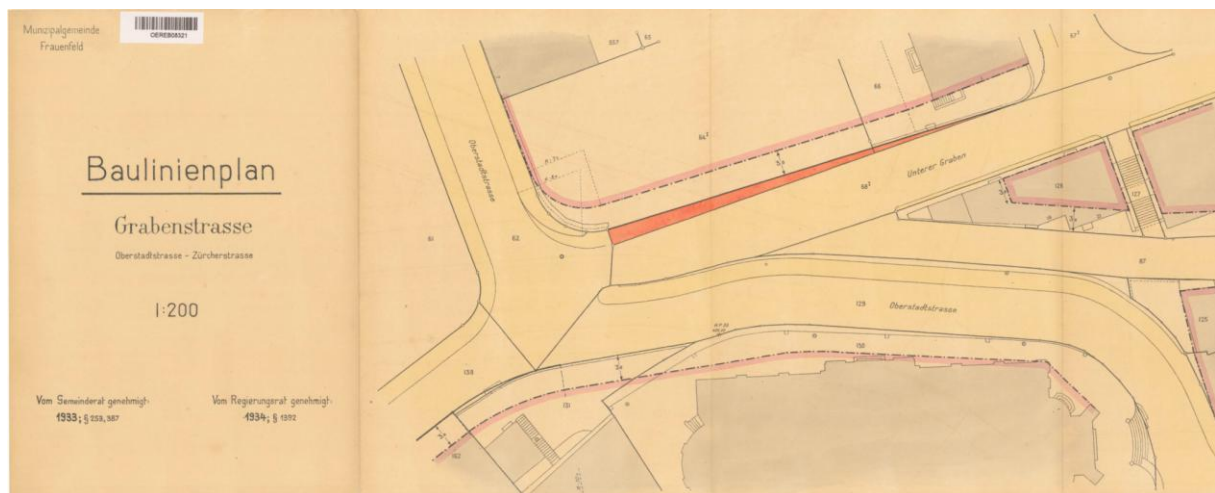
Ausschnitt Baulinienplan Grabenstrasse (RRB Nr. 1392 vom 25.06.1934)
